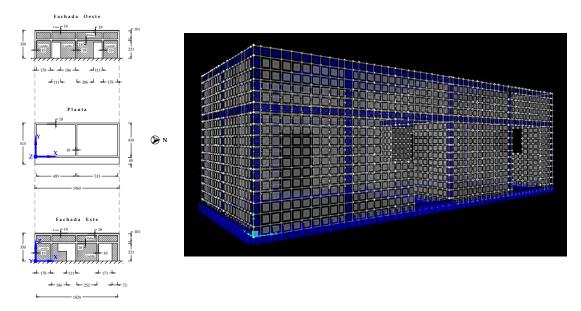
Modelo estructural de la vivienda 1.
